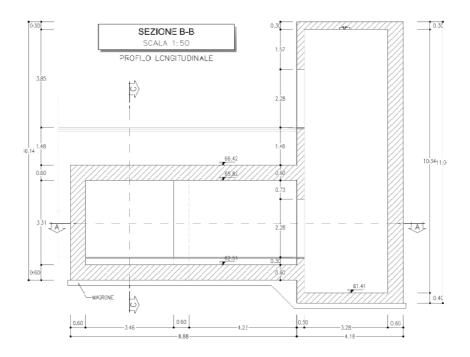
Sezione longitudinale corridoio di collegamento torrino montacarichi
